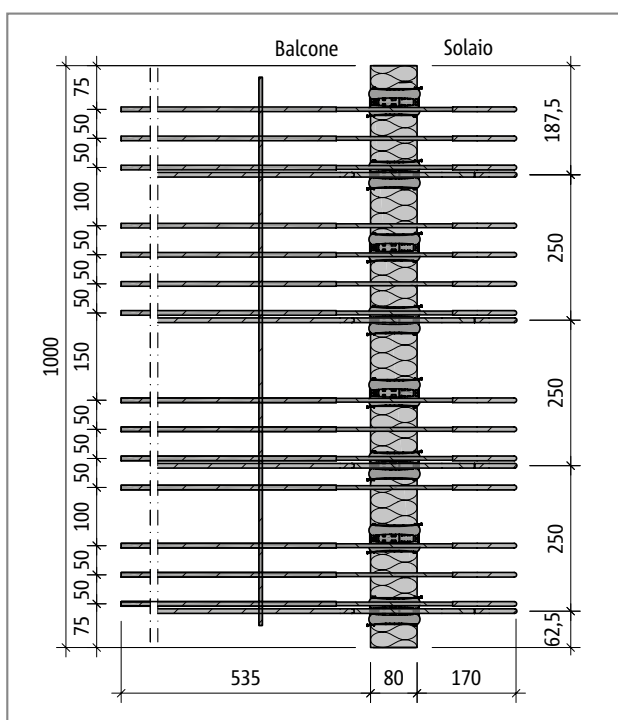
Schöck Isokorb® tipo K50S-UZ: pianta del prodotto
